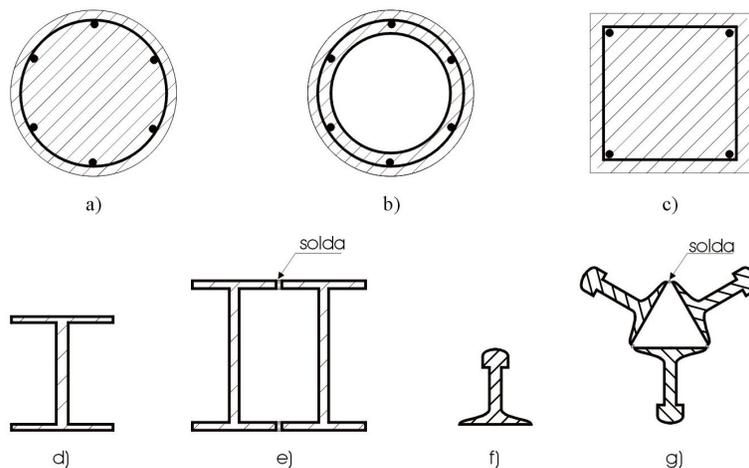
Exemplos de seções transversais de estacas: a) estaca circular de concreto; b) estaca circular oca de concreto; c) estaca quadrada de concreto; d) perfil metálico H ou I; e) perfil metálico duplo I; f) trilho simples; g) perfil formado por três trilhos soldados
